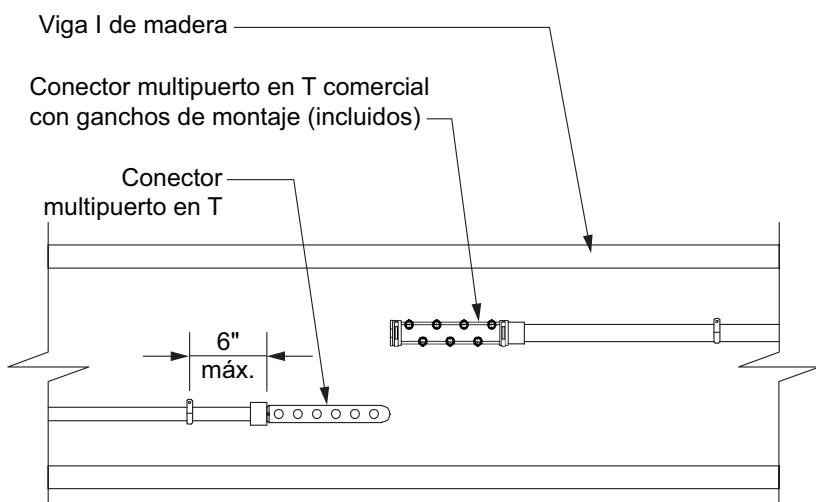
Apoyando a conectores multipuerto en T en vigas I de madera
